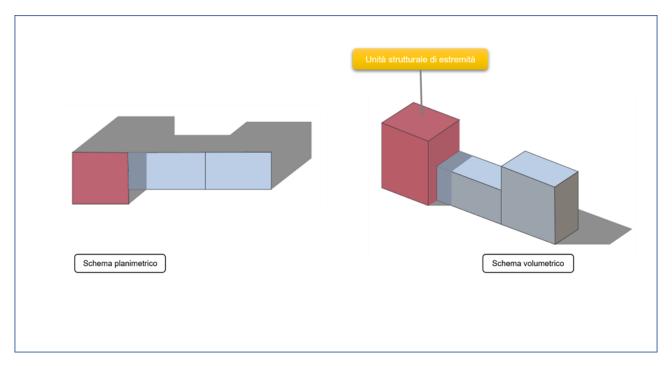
UNITÀ STRUTTURALE IN POSIZIONE D'ESTREMITA'
